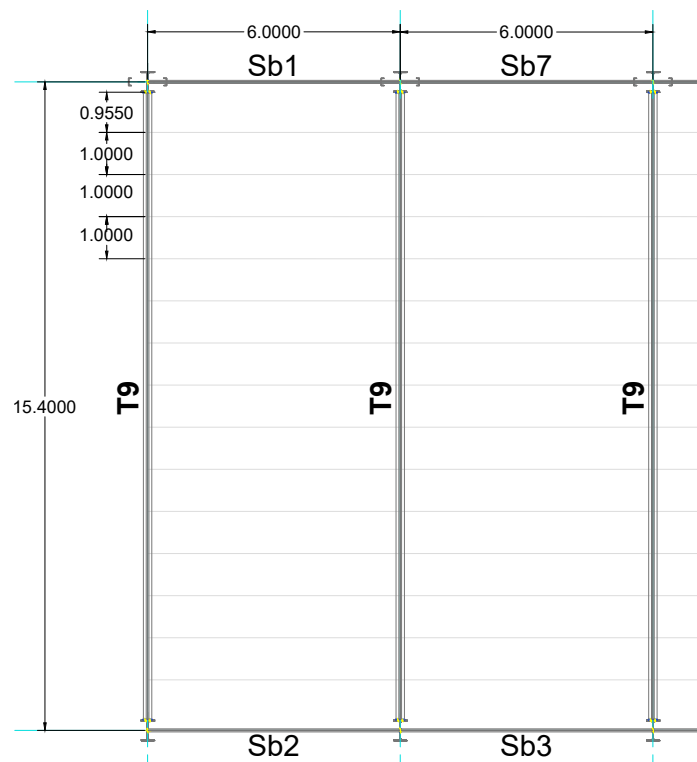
Maintien latéral des poutres principales par le plancher collaborant
